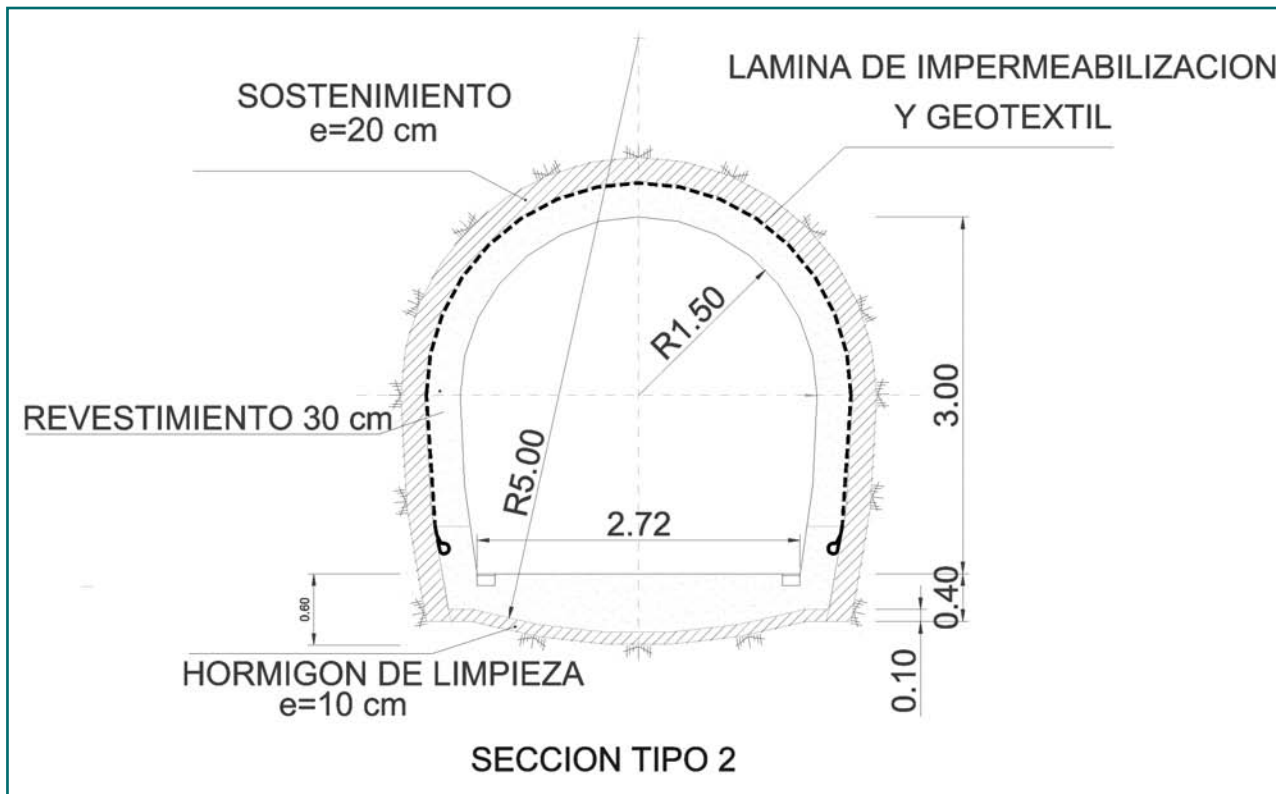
Sección tipo de la galería de conexión/Standard section of connection gallery.
